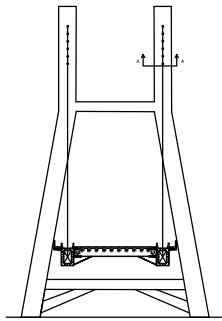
DETAIL SAMBUNGAN SAYAP BOX GIRDER
